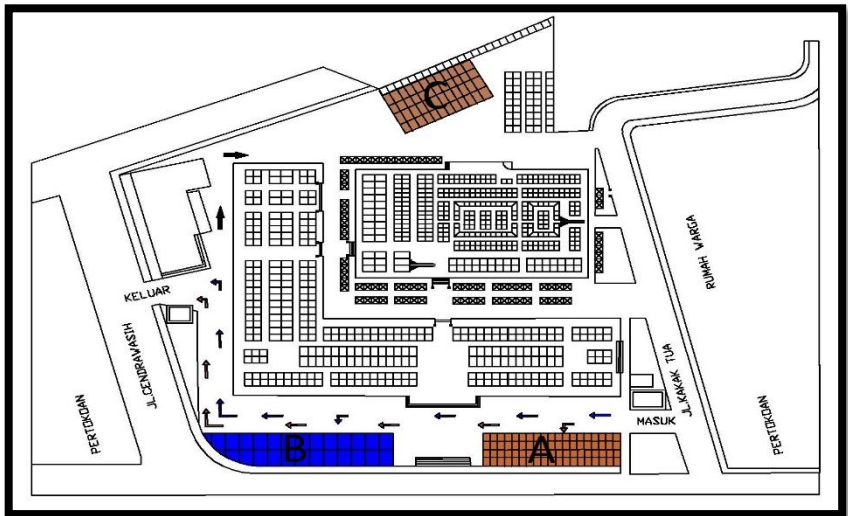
Layout Sirkulasi Ruas Jalan Raya di sekitar Pasar Srimangunan Sampang
